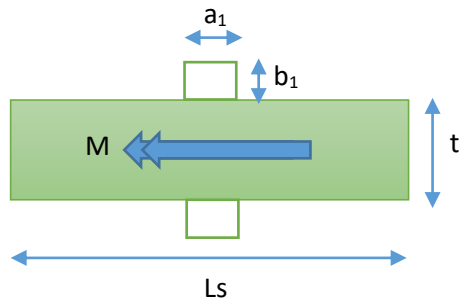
Sección de muro de tapial con refuerzos de postes de madera de sección rectangular
